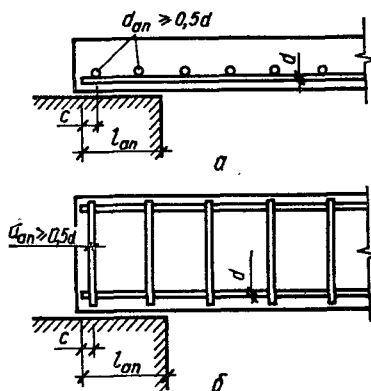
Дополнительная анкеровка арматуры поперечными анкерующими стержнями:
